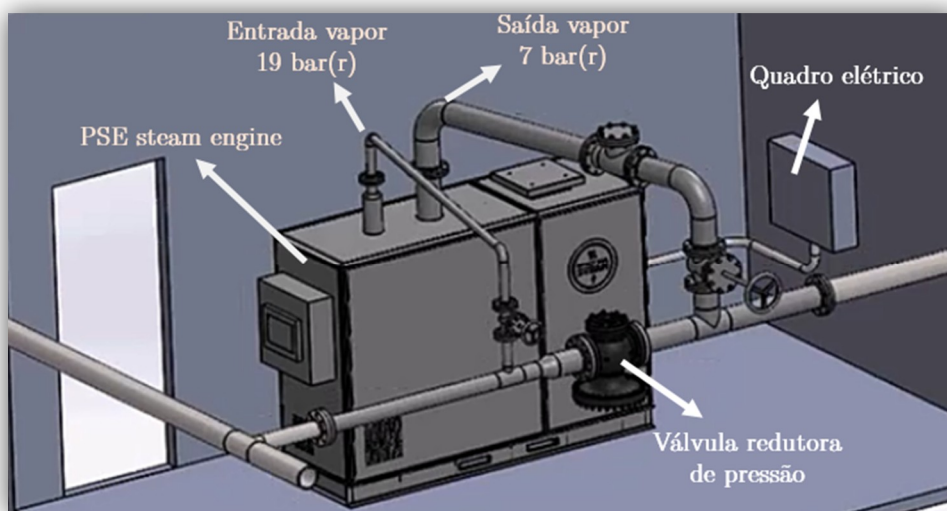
Esquema de montagem do motor, adaptado de (46).
